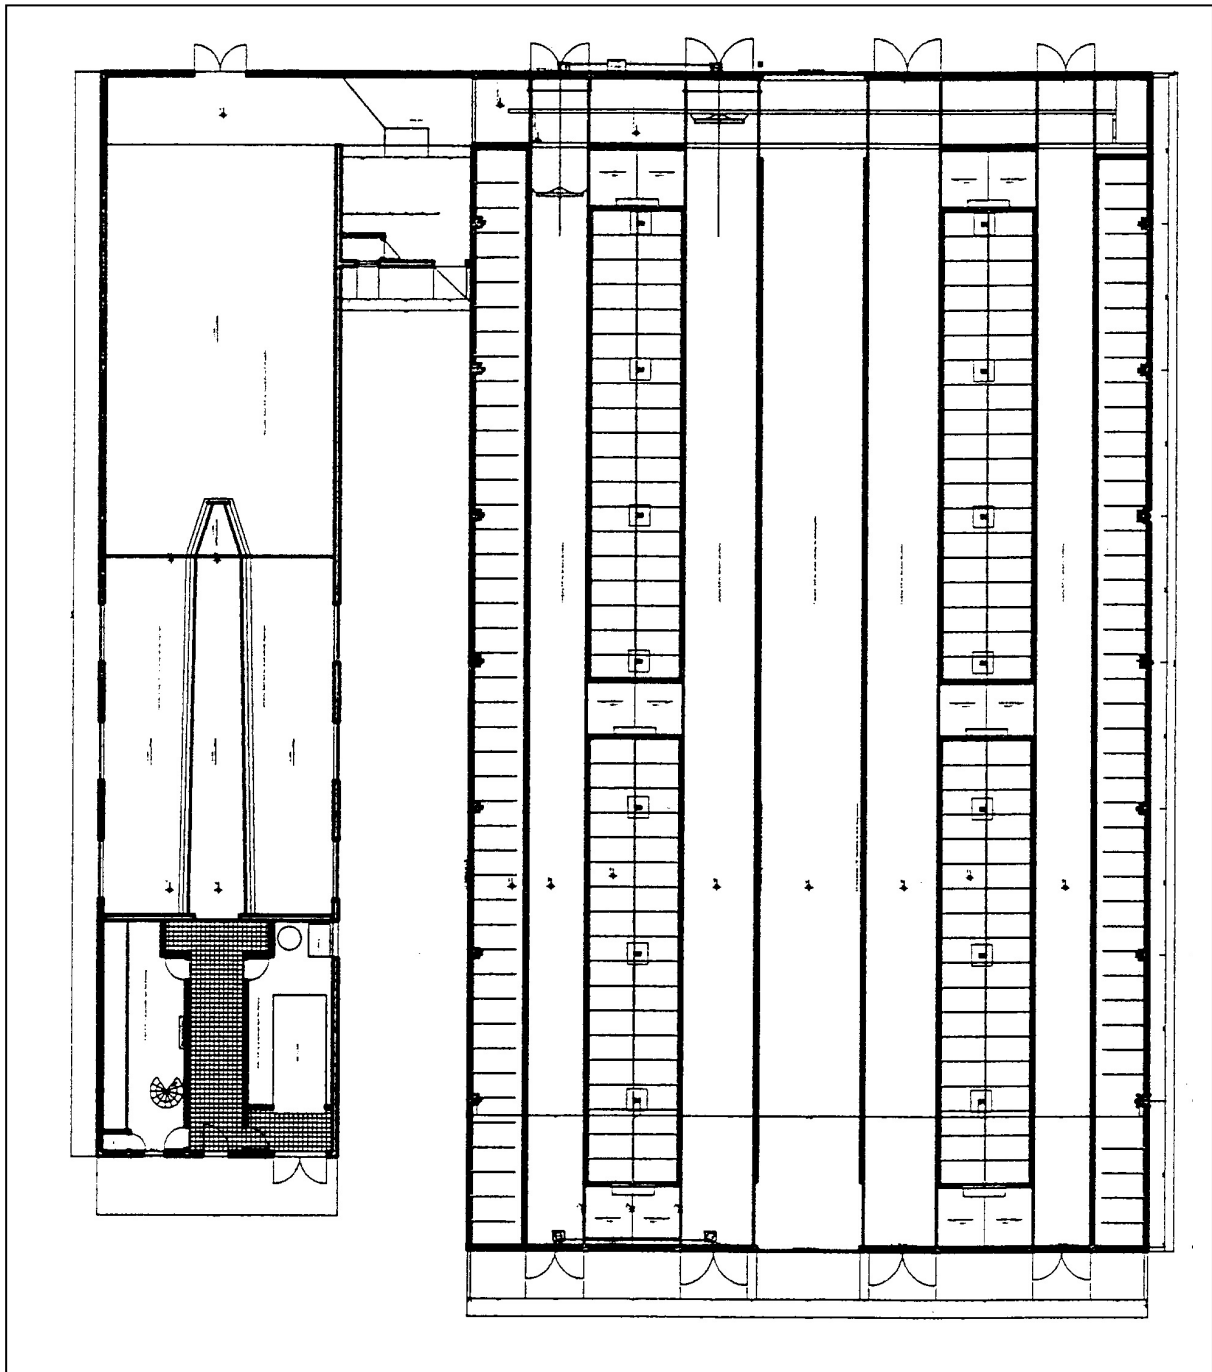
Grundriss Milchviehstall M&M Kneipp GbR
